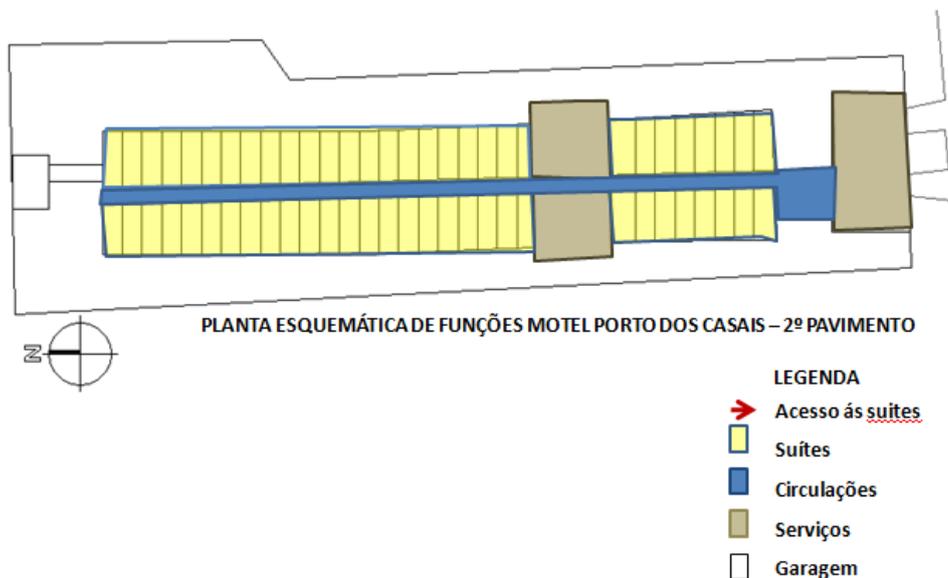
Planta esquemática do pavimento 2º pavimento (AUTORA, 2010).
